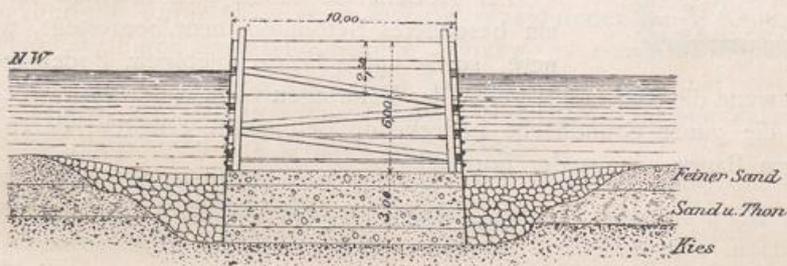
Eiserner Mantel mit Betondichtung und Versteifung der Wandungen.
